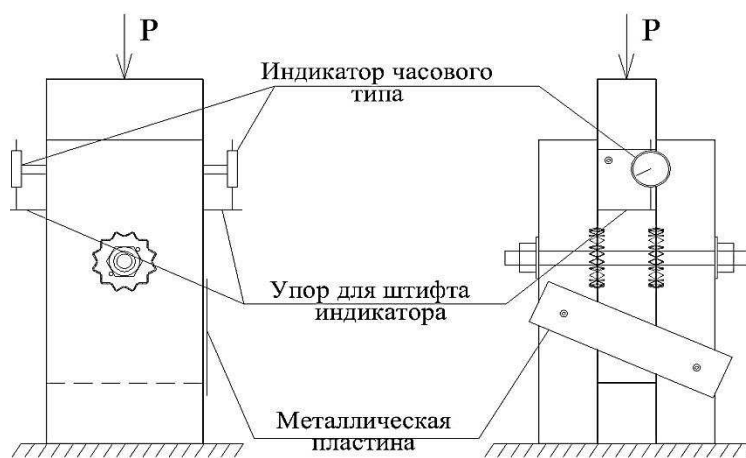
Схема проведения длительных испытаний соединений на сжатие
